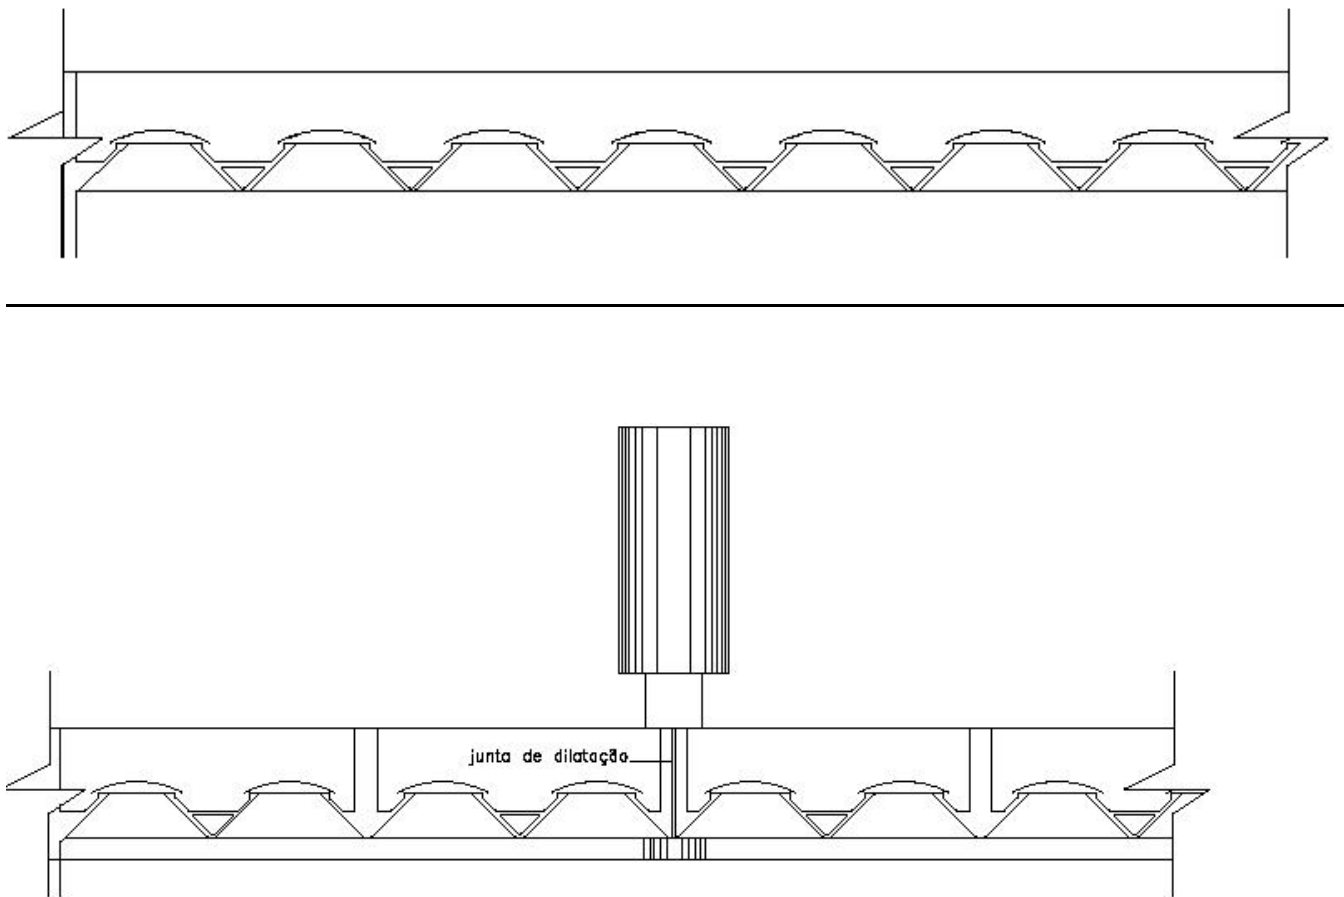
Cortes do edifício Vilanova Artigas. O corte transversal (primeiro corte) mostra as seções das vigas em formato de A, vazadas, que ainda guardam a fôrma de madeira usada na concretagem em técnica conhecida como caixão perdido. O corte longitudinal (segundo corte) ilustra as seções das vigas vazadas e das vigas de seção plena.
